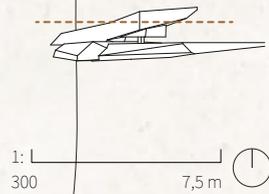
| Grundriss Ebene + 10,50m
